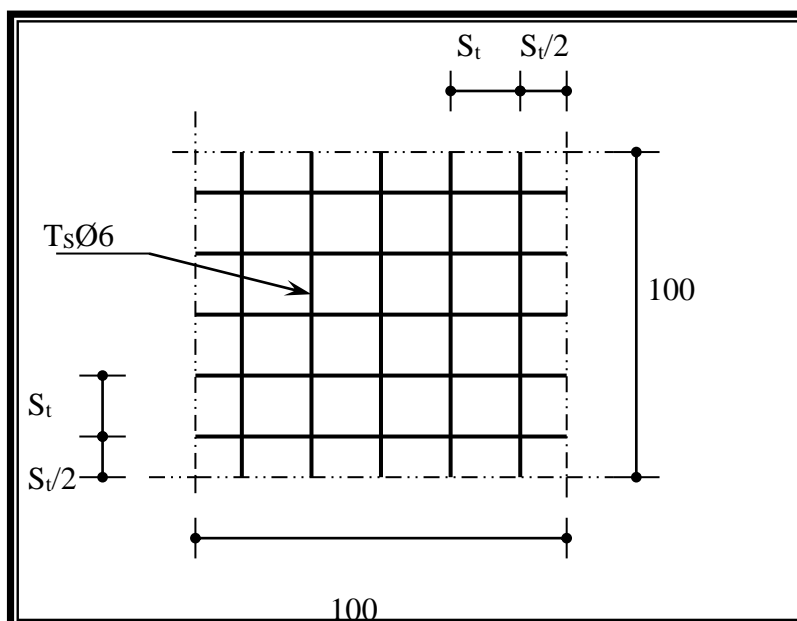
Disposition constructive des armatures de la dalle de compression
